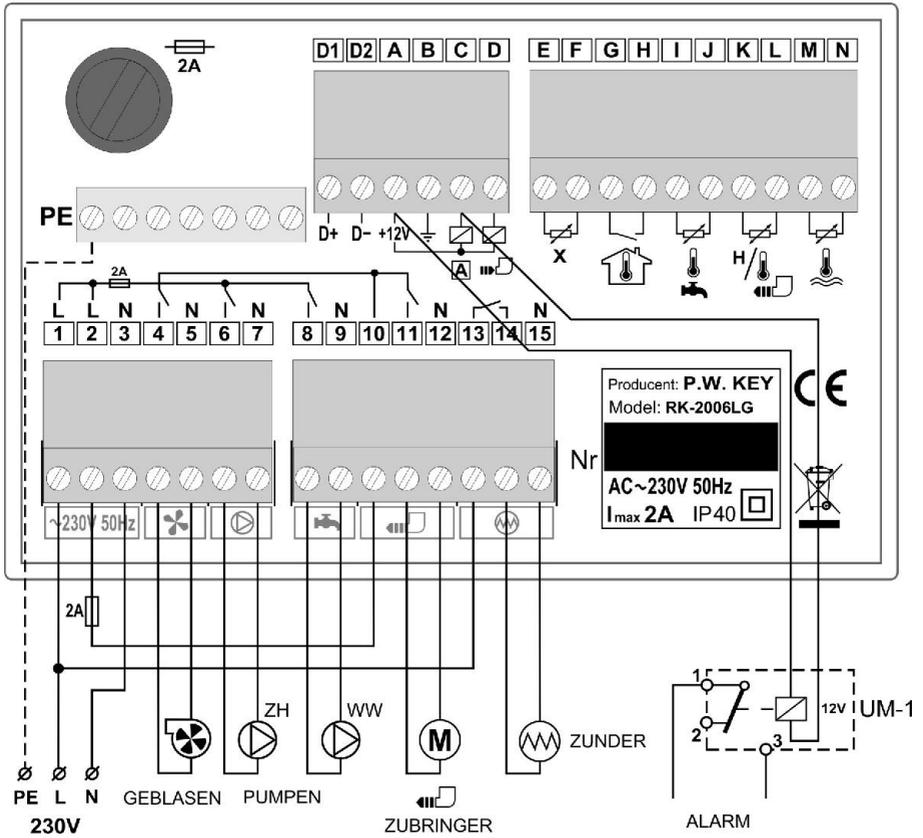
Anschlussschema des Reglers RK-2006LG (mit Alarmmeldersystem).
